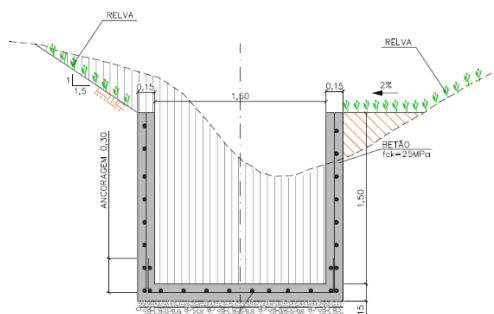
Secção tipo de betão armado, projeto de execução (BDM, 2017)
